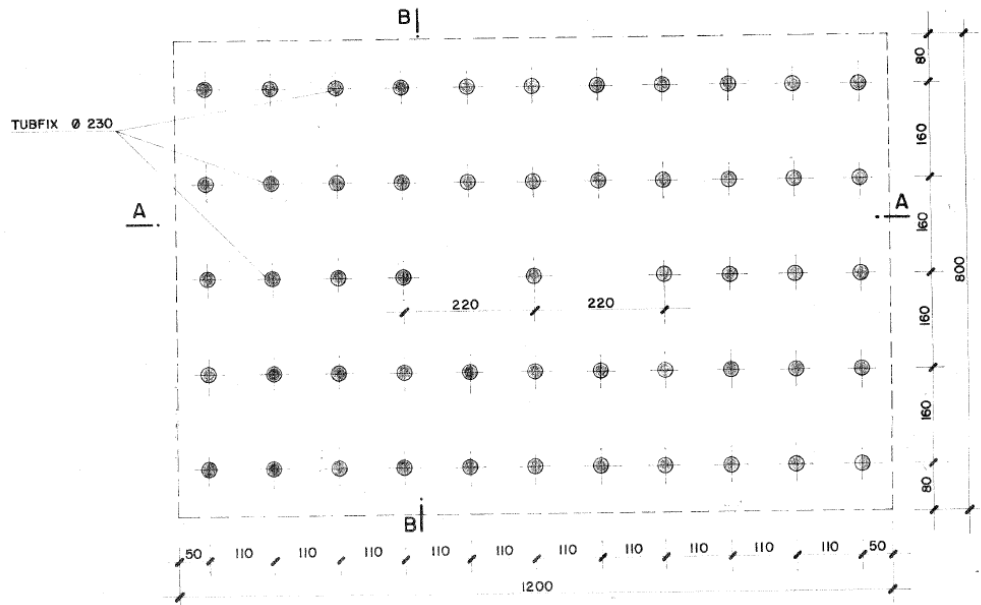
Pianta Spalla A e spalla B su micropali
